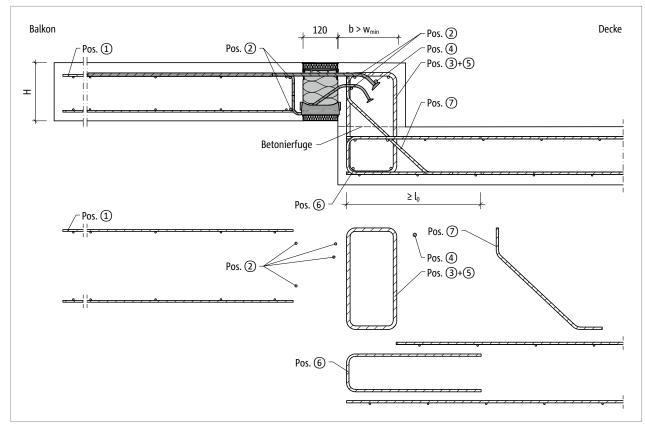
Schöck Isokorb® XT Typ K-O: Bauseitige Bewehrung für Balkon mit Höhenversatz nach oben mit größerer Bauteilabmessung (w<sub>vorh</sub> > w<sub>min</sub>)
